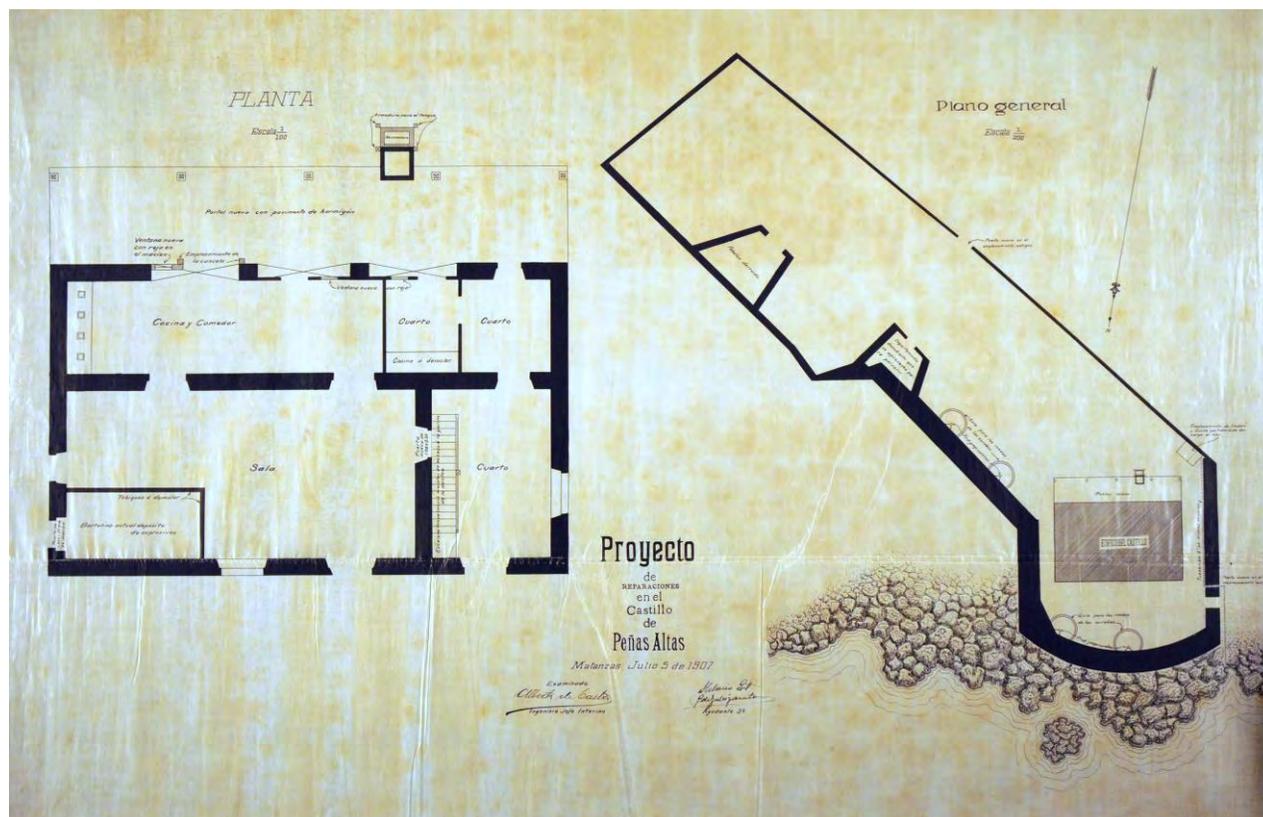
Planta de la batería de Peñas Alta con detalle de las divisiones internas del edificio, elaborado por Alberto de Castro (1907).
